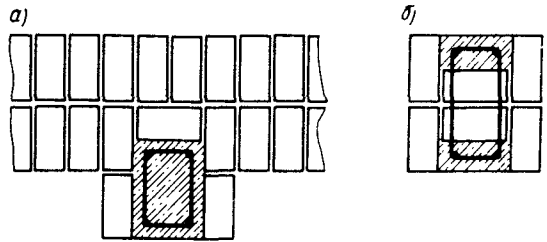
Схемы поперечных сечений комплексных конструкций:
